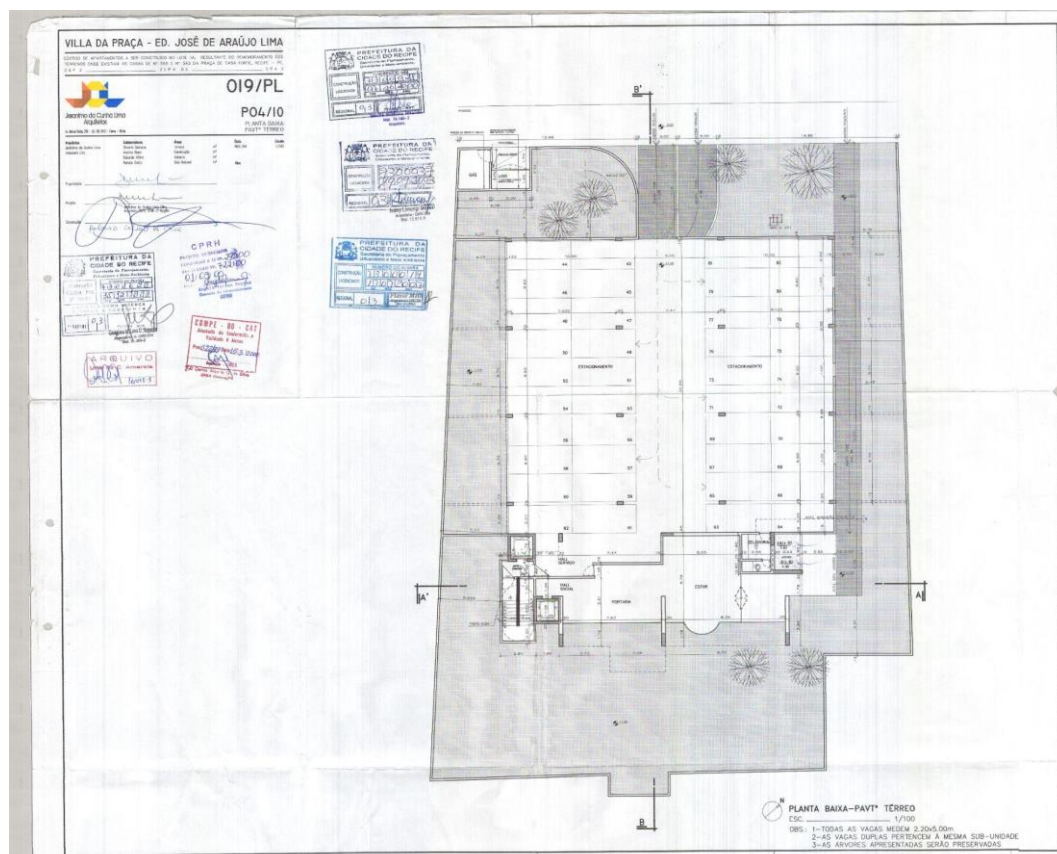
Planta Baixa do Pavimento Térreo do Edifício Villa de Praça. Fonte: Arquivo da Prefeitura de Recife (1999).
